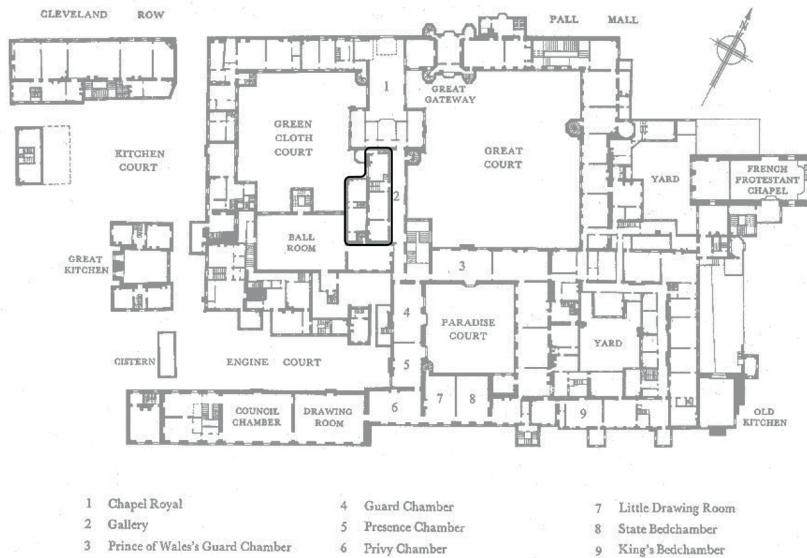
Plan St. James's Palace First Floor 1729⁶⁷⁸
